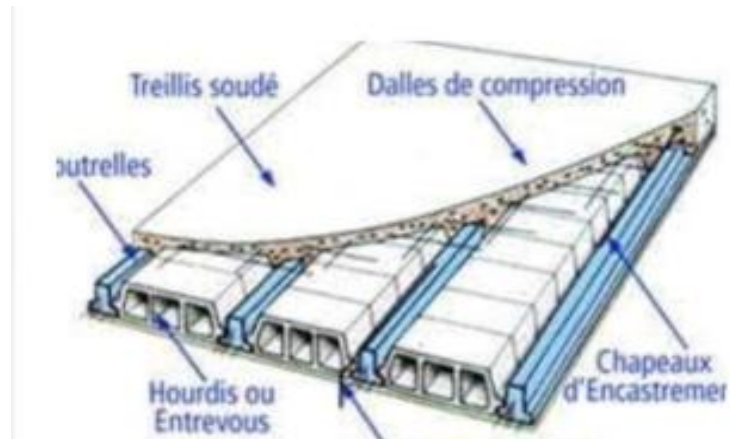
Le rôle de l'hourdis sur le plancher (dalle de compression). [43]
